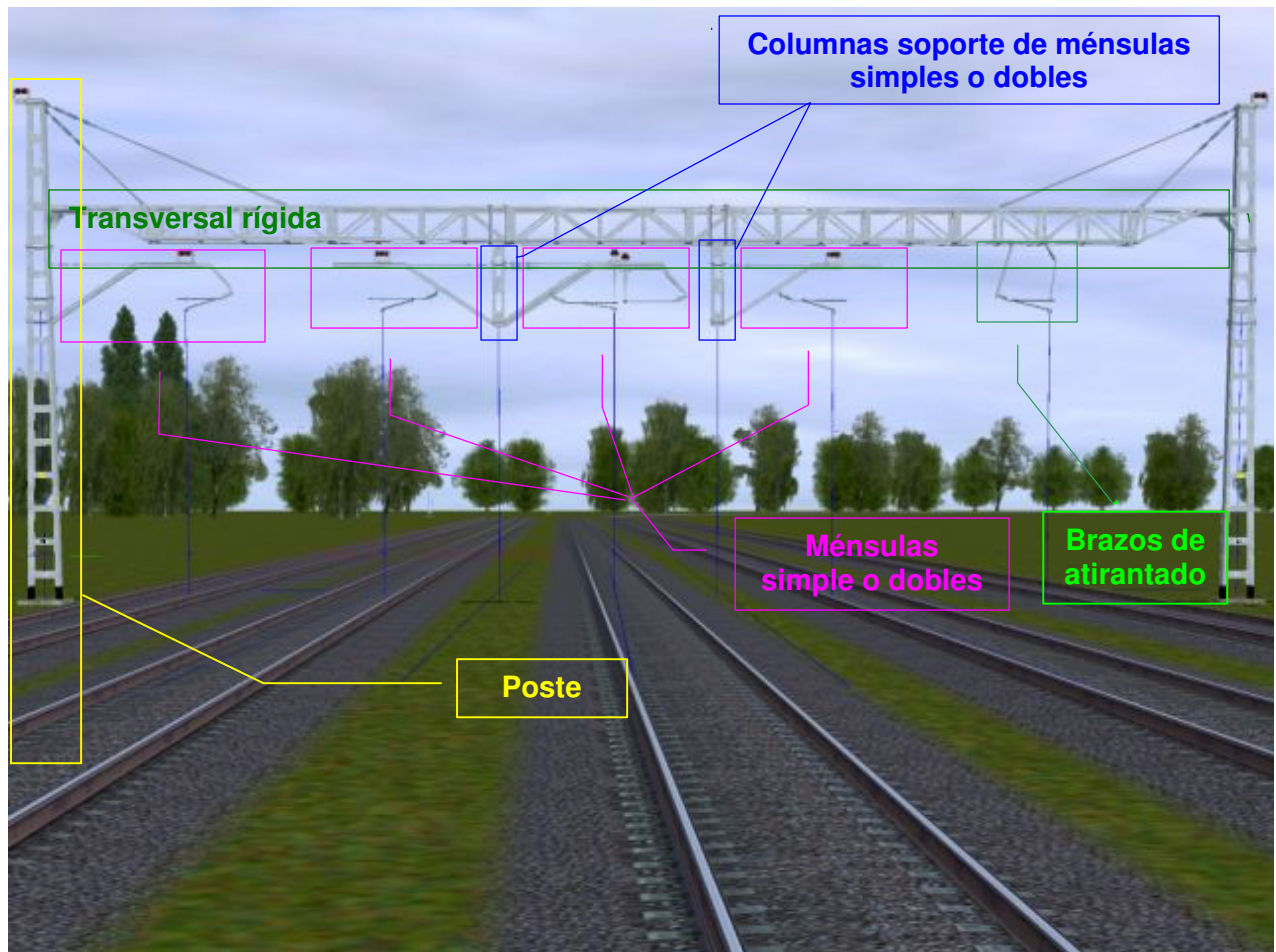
Elementos constituyentes de un pórtico rígido.
